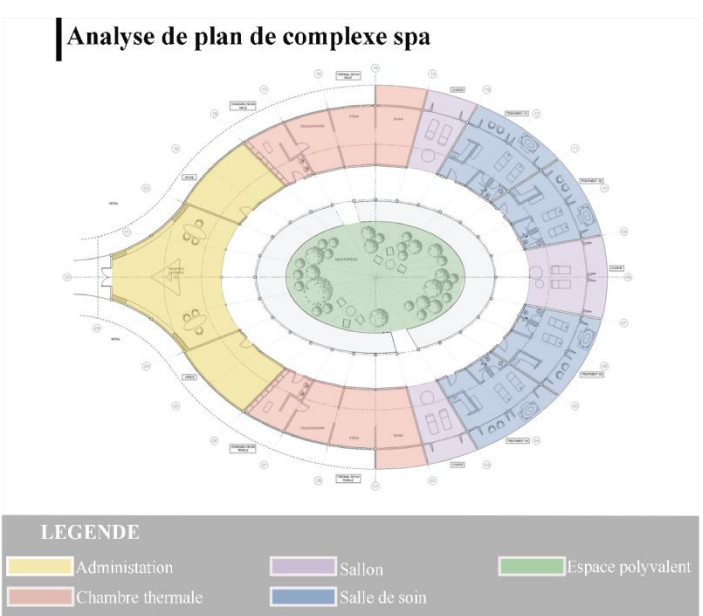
Plan d'équipement de Spa du complexe , source : Archdaily ,traitée par auteurs, 2025
